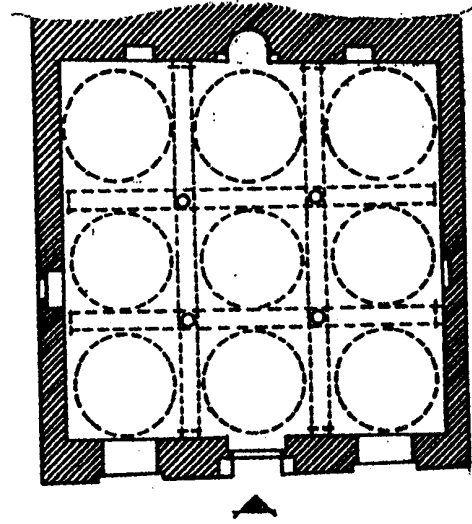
مسقط أفقي لمسجد تيند باليمن
